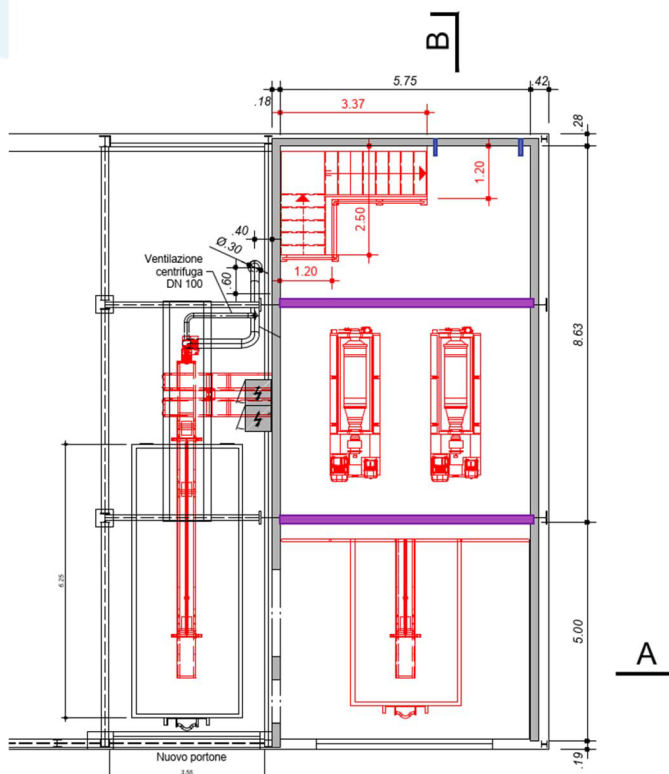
Dettaglio struttura portante soppalco centrifughe
